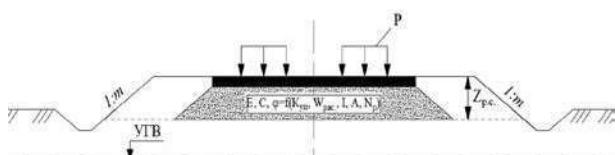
Схема земляного полотна из засоленного грунта в поперечном профиле
